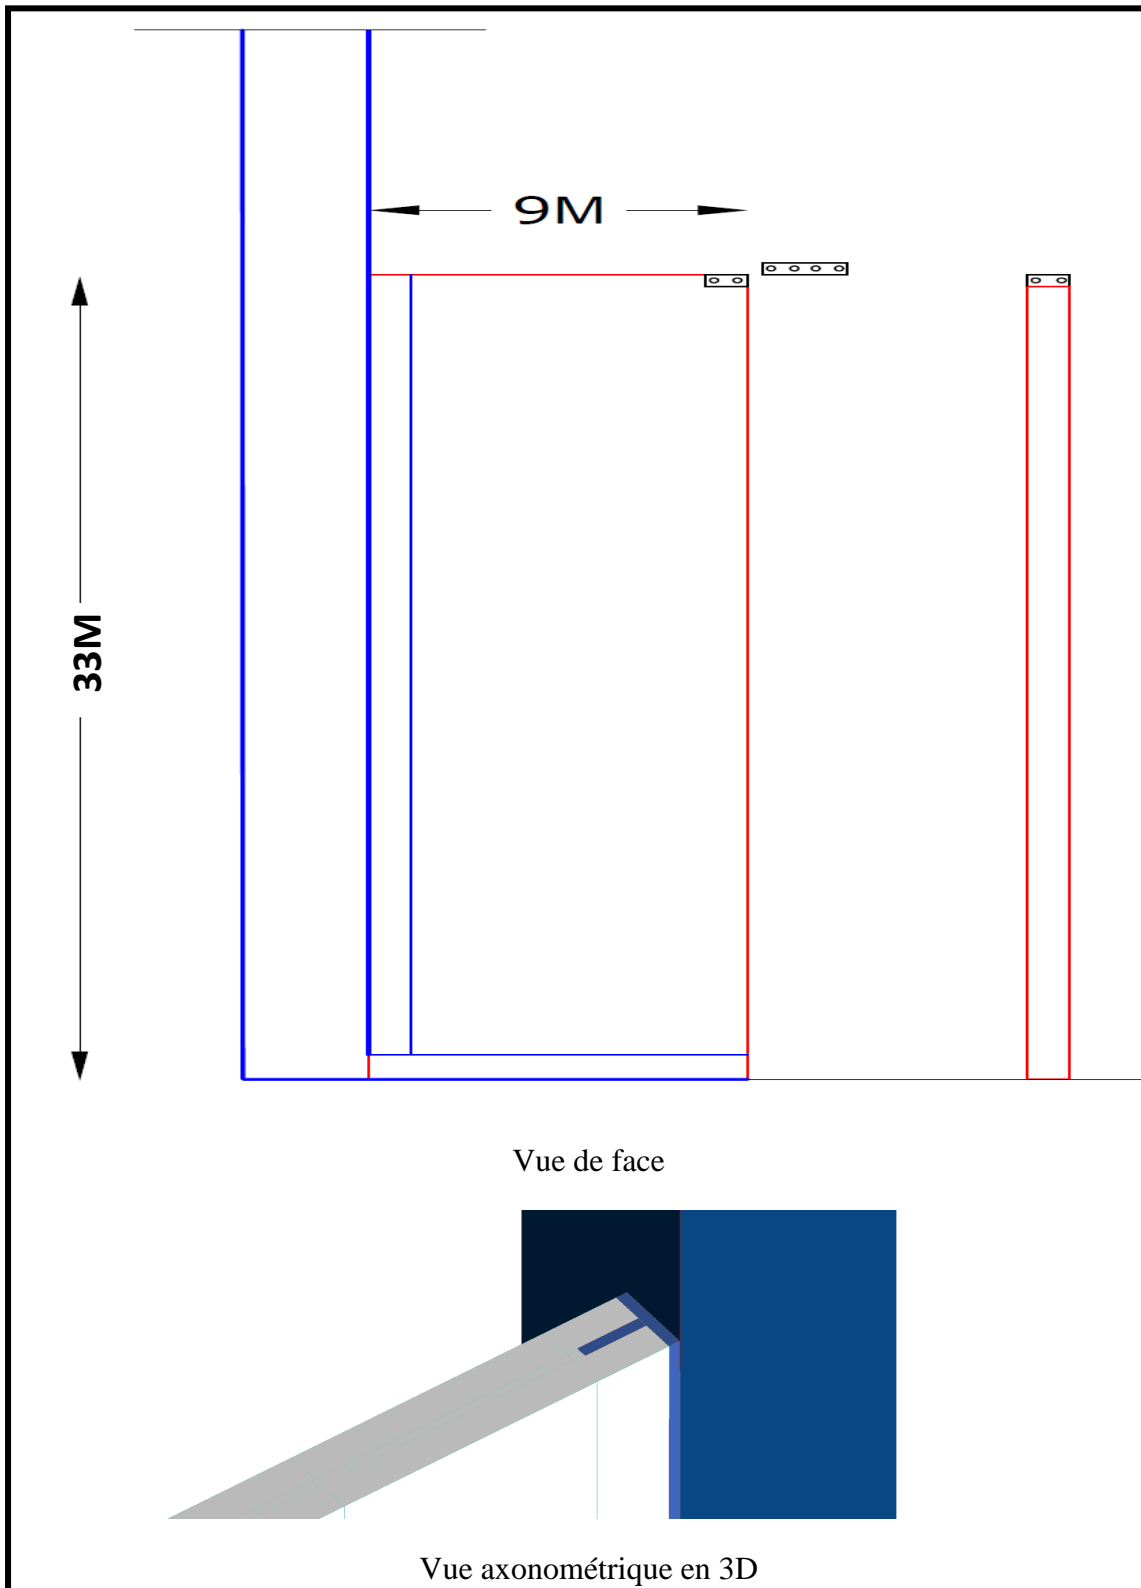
Détail d'assemblage d'un mur de partition avec un poteau
